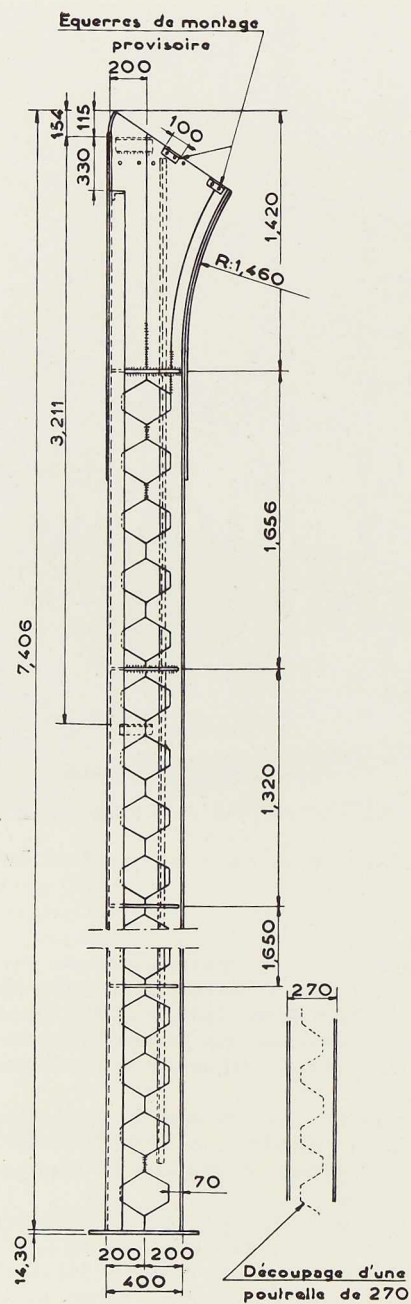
Poteau de rive, la hauteur de la poutre H 27 a été portée à 400 mm par découpage suivant une ligne imbriquée, et réassemblage par soudure.
